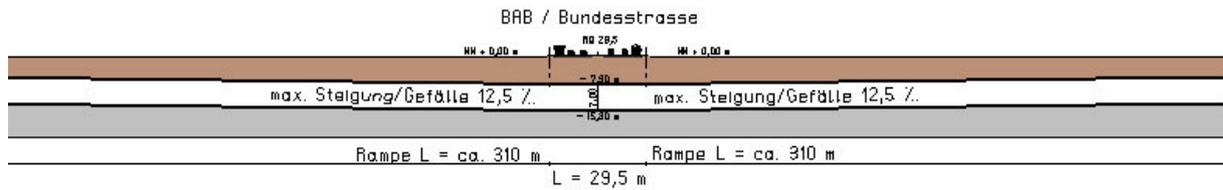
Längsschnitt Unterquerung BAB / Bundesstraßen, Detail
